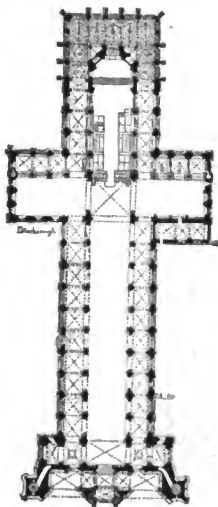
Grundriss der Kathedrale von Peterborough. (Nach Britton.)
